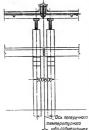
14. Поперечный температурный шов на парных колоннах.
